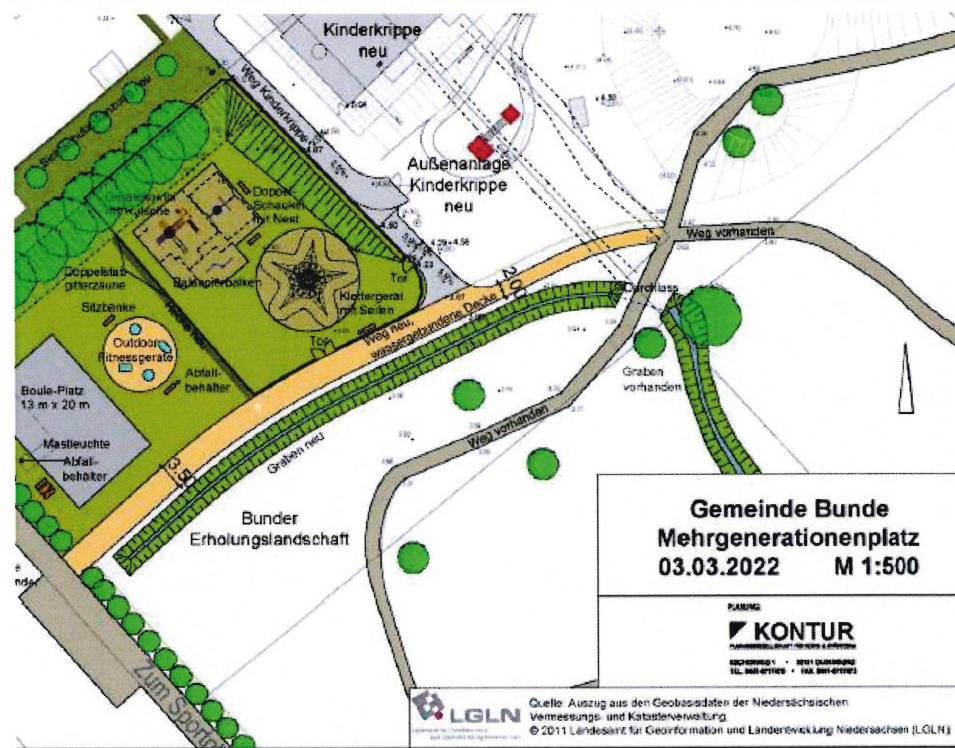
Dränageplan (Quelle: Kontur Oldenburg 2022)
